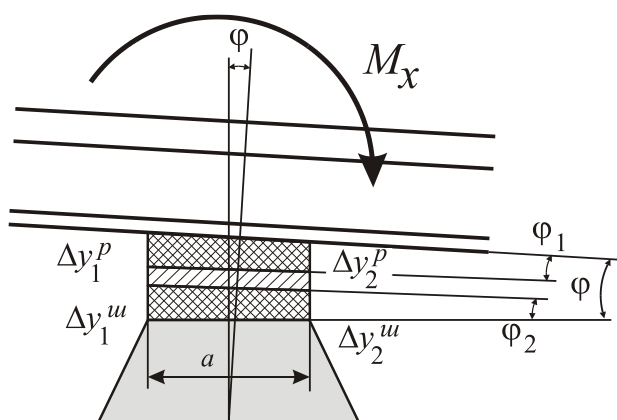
Расчетная схема для определения угла поворота сечения рельса
